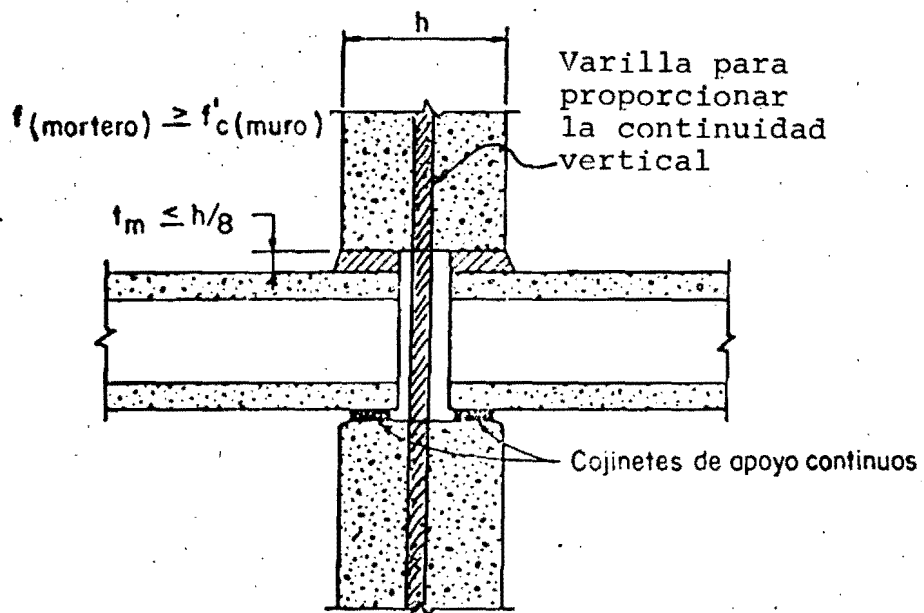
Detalles de una conexión horizontal interior muro-losa-muro típica de E.U. sin mortero (ref 8)
